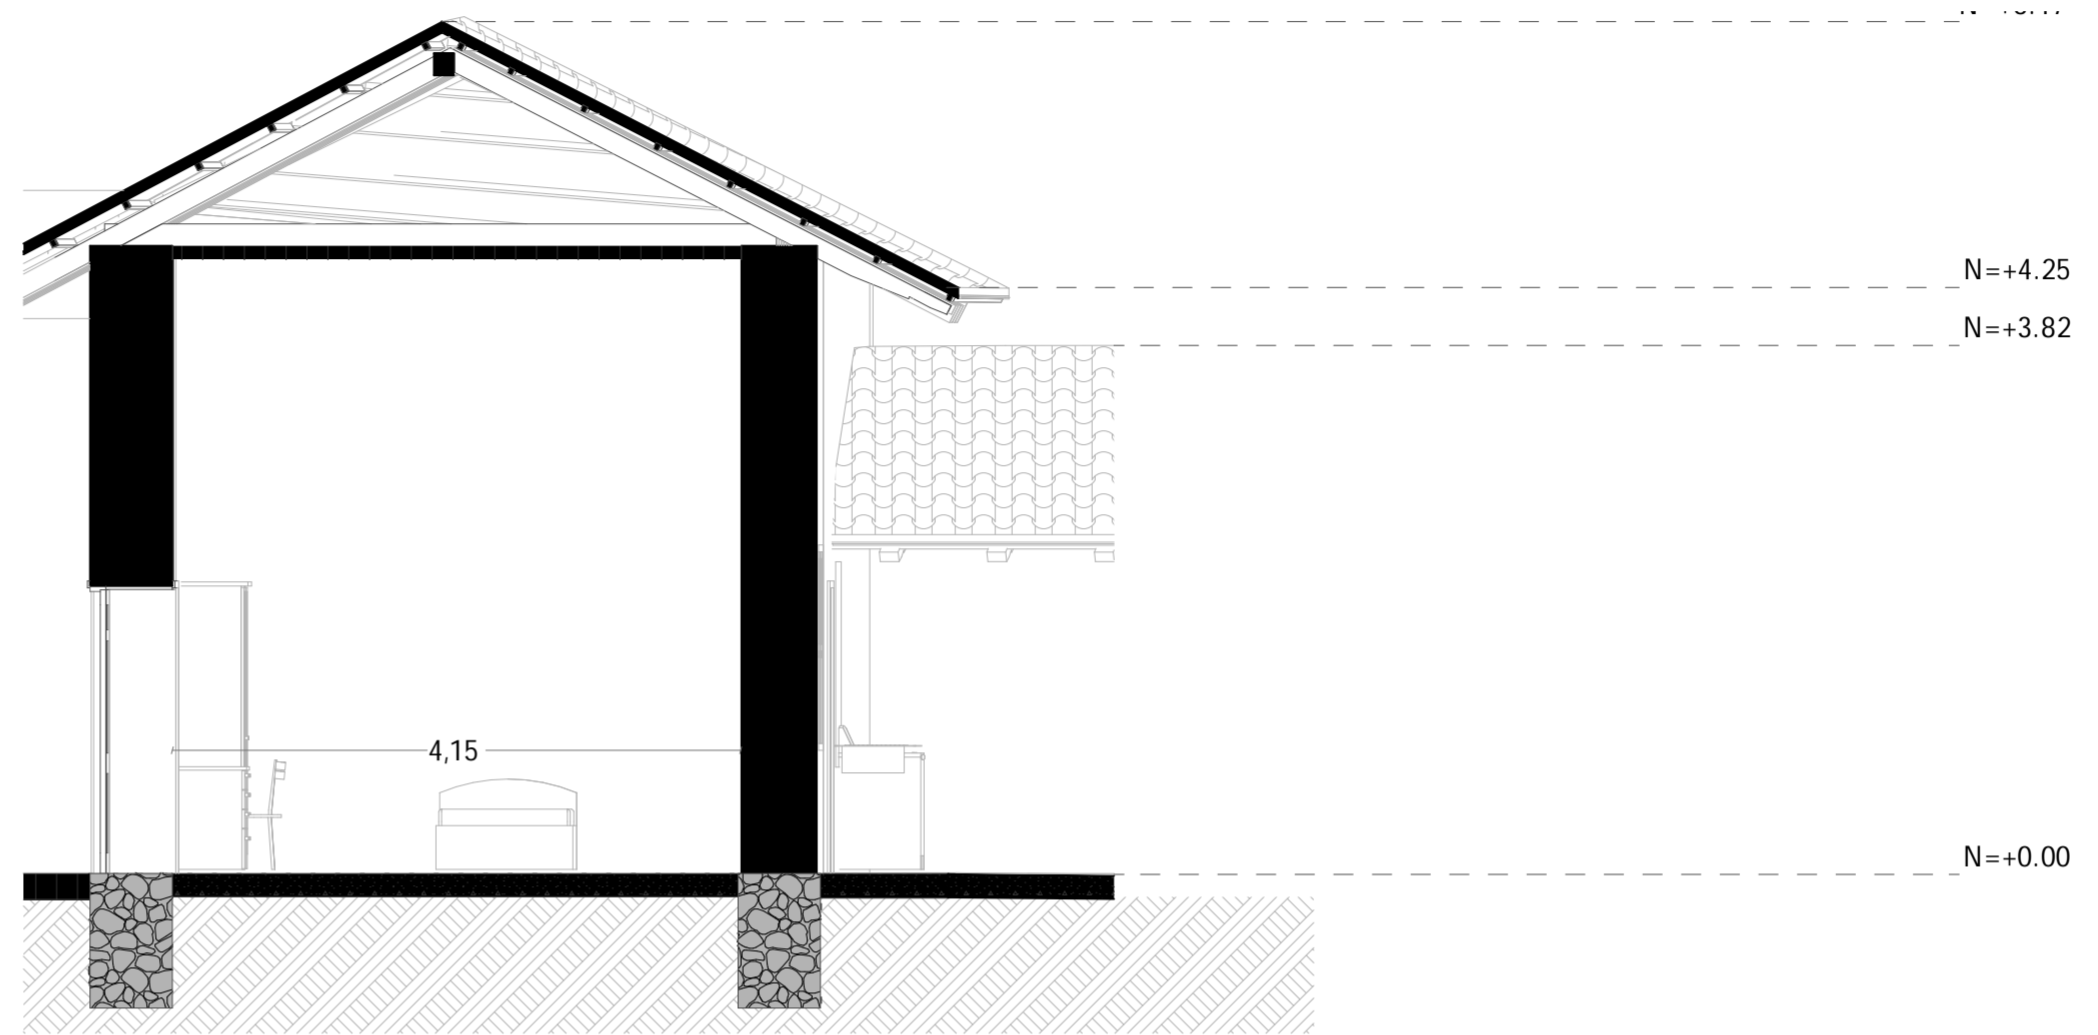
Cortes y detalle constructivo del bloque A del proyecto Casa Rodriguez
